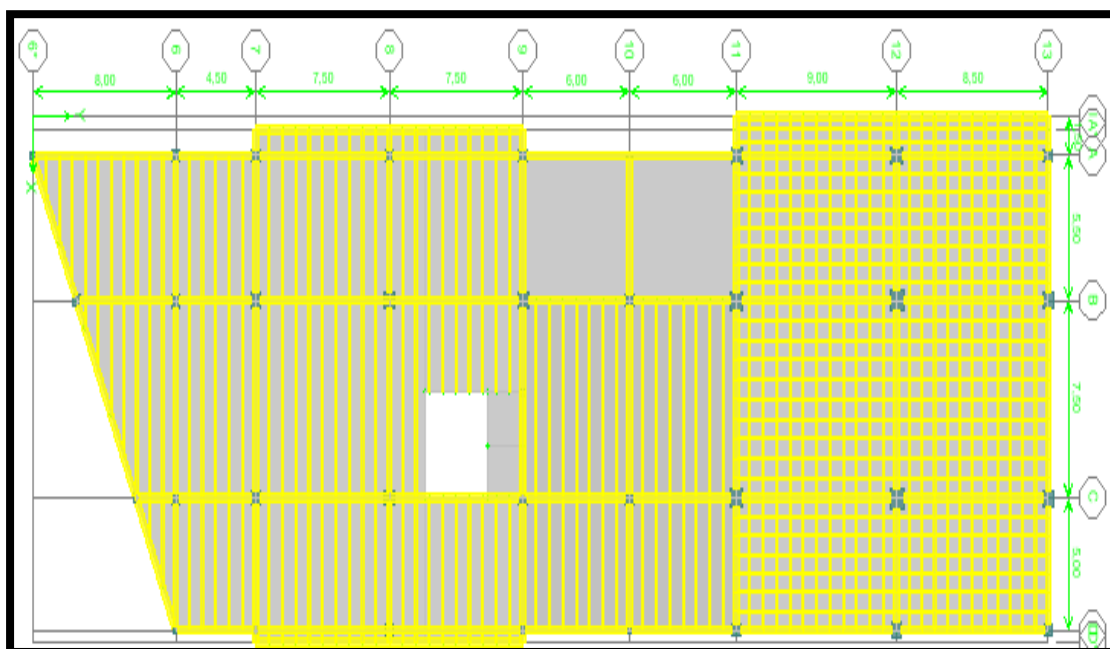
Planta tipo Edificio Sur-Oeste (Nivel 1)
